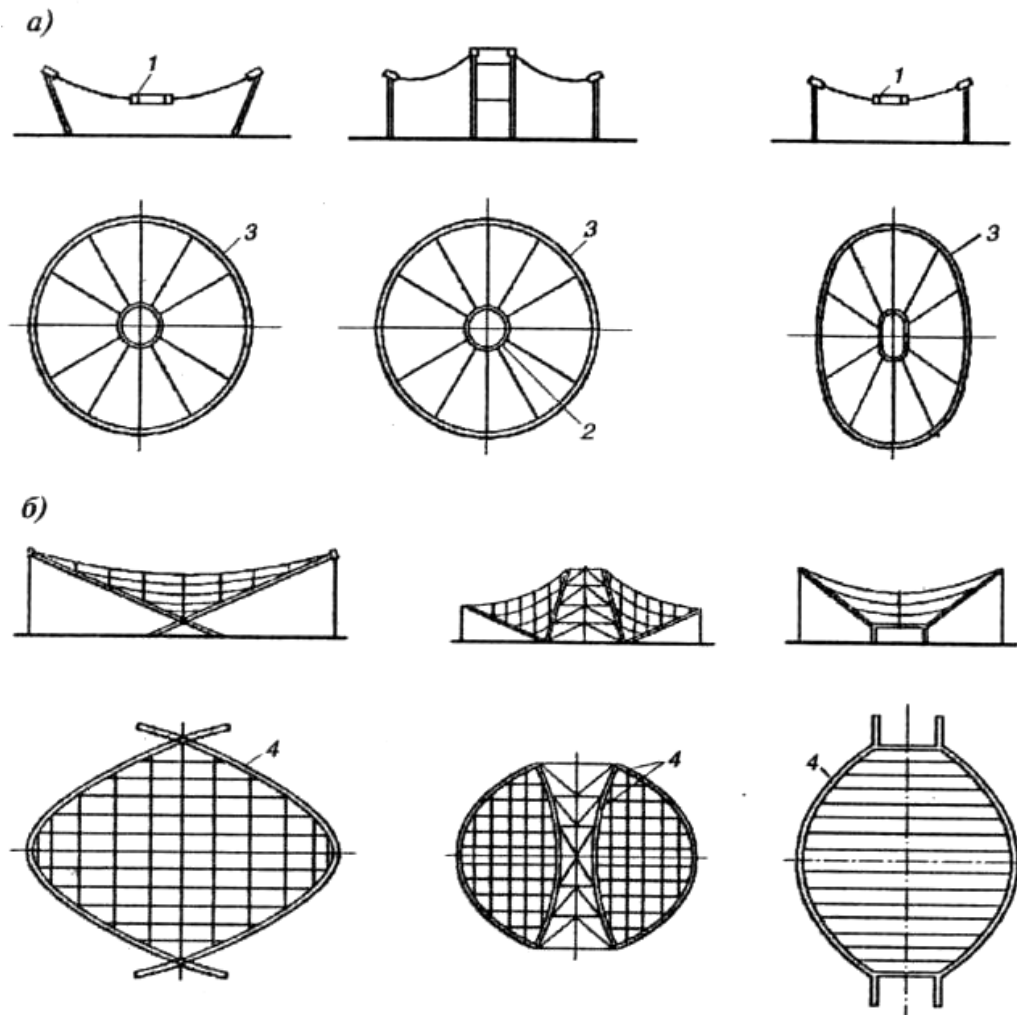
Схемы круглых и арочных опорных конструкций: а – круглых; б – арочных; 1 – внутреннее кольцо; 2 – то же, опорное; 3 – наружное опорное кольцо; 4 – опорные арки
